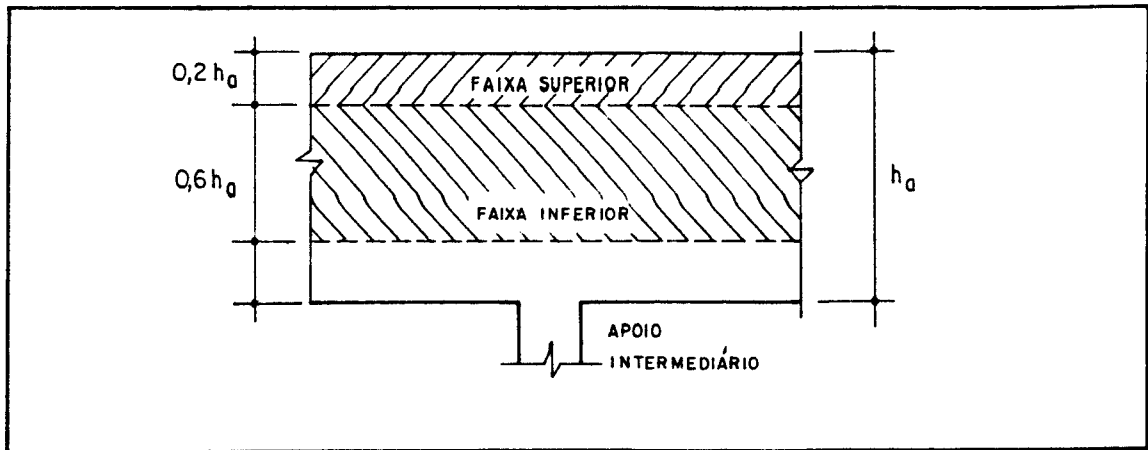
Distribuição da armadura longitudinal sobre os apoios intermediários de vigas parede contínuas(Ref. 6).
